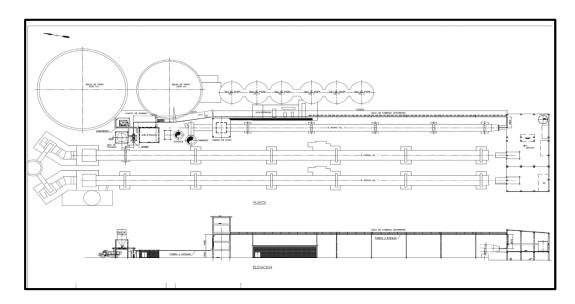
Planos del área de cocción planta Lara. Fuente: Márquez (2016).
